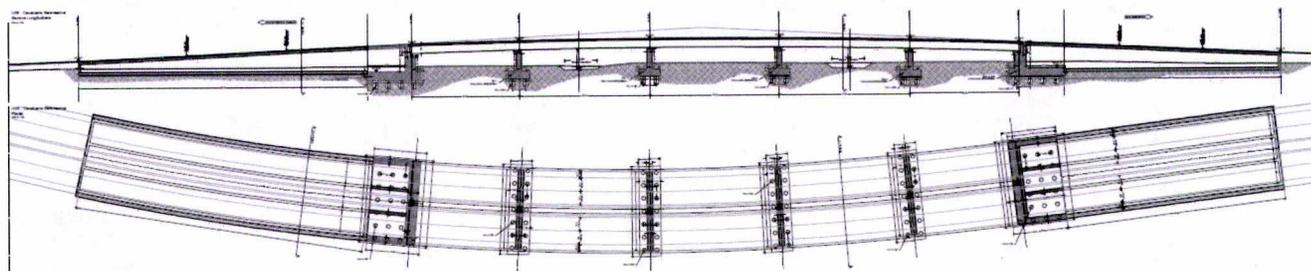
Planimetria e Profilo del Cavalcavia Serenissima
